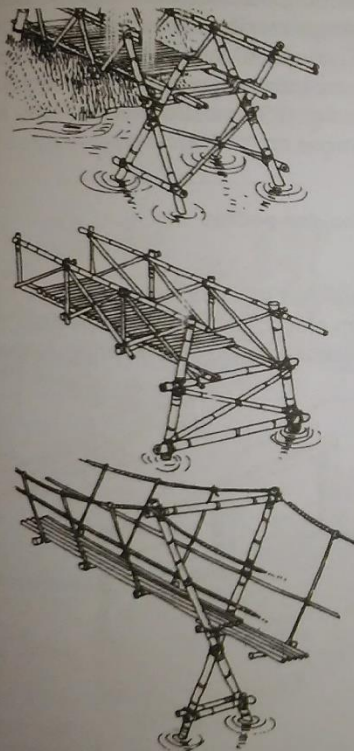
Esquemas construtivos de pequenas pontes executadas em bambu.
